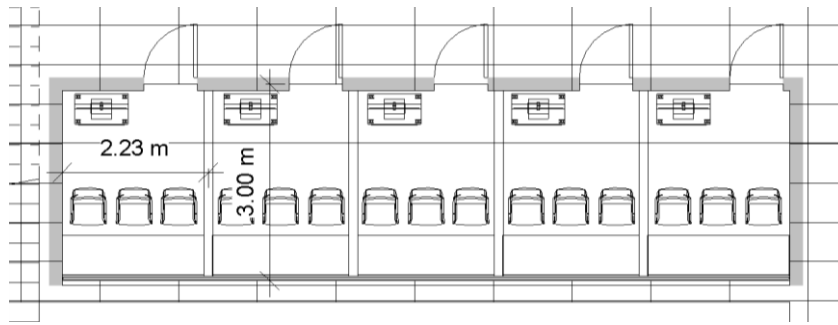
Vista en planta de las cabinas de transmisión. Fuente: elaboración propia.
